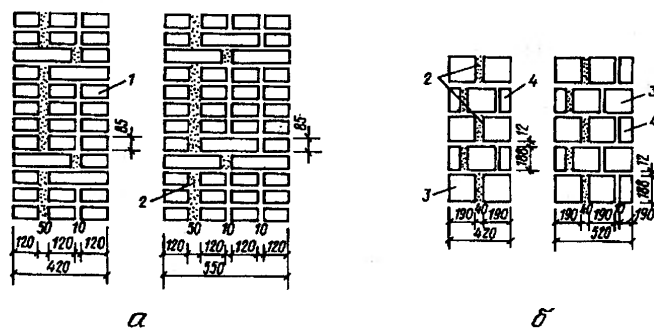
Кладка с уширенным швом: а – кирпичная кладка; б – из бетонных камней с щелевидными пустотами; 1 – кирпичная кладка; 2 – уширенный шов, заполненный теплоизоляционным материалом или раствором; 3 – целый камень; 4 – продольная половинка
